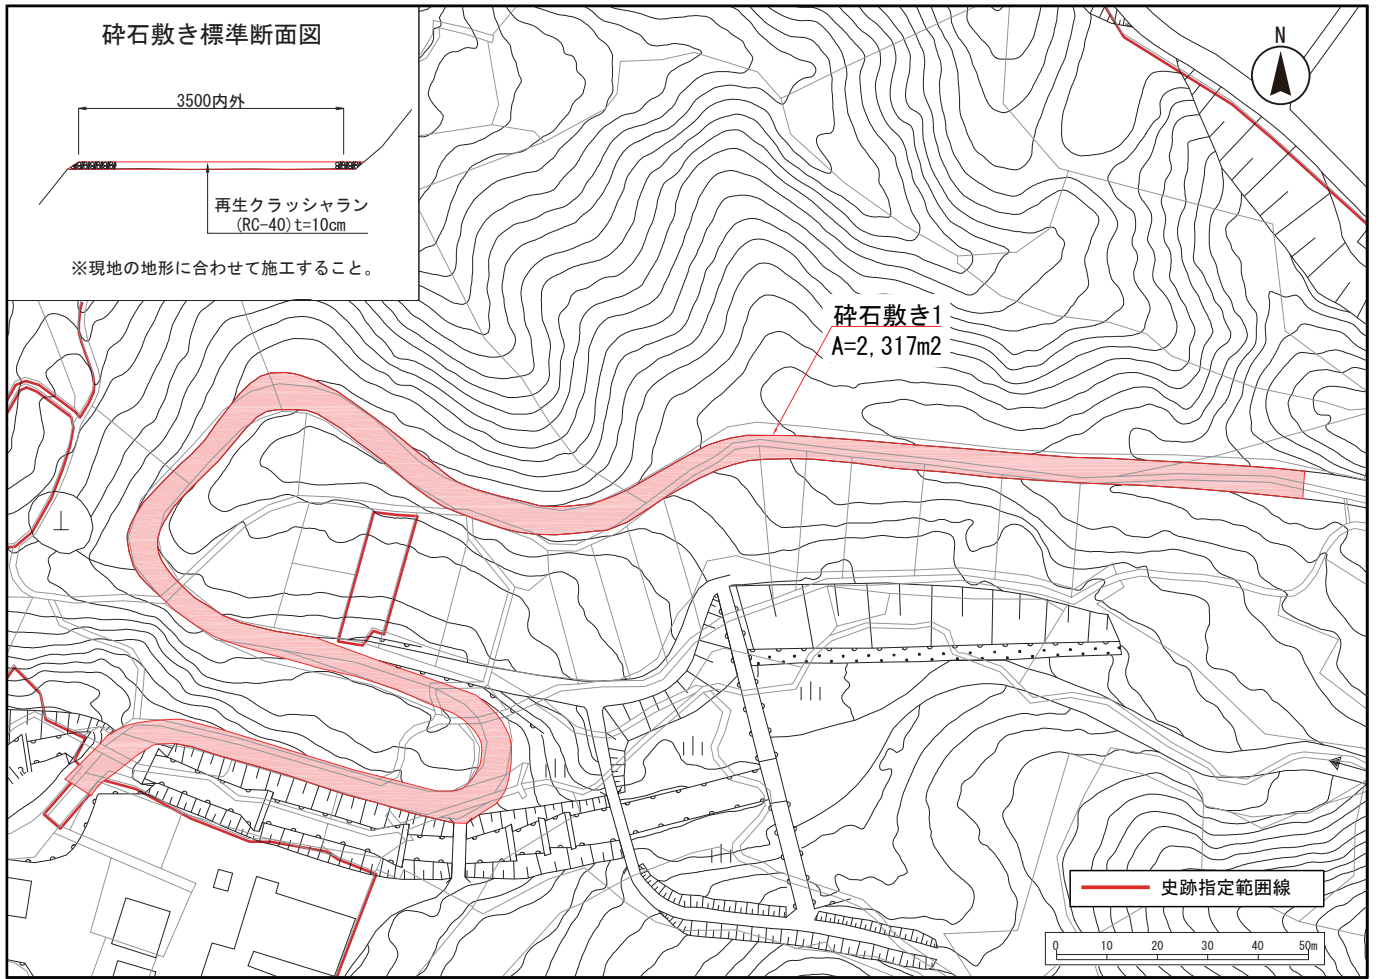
碎石敷き 1 計画平面図 (案) (1/1,500)
